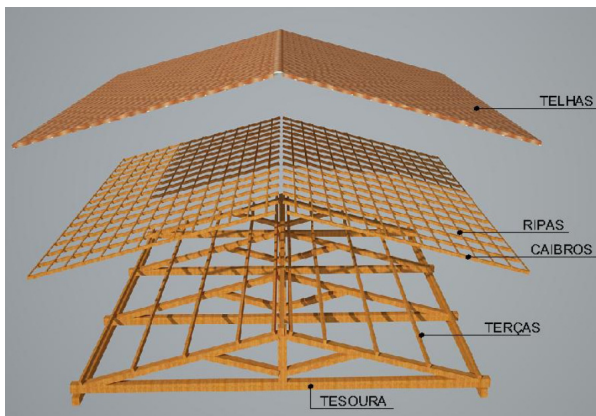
Elementos estruturais componentes dos telhados coloniais; Melo (2011).
